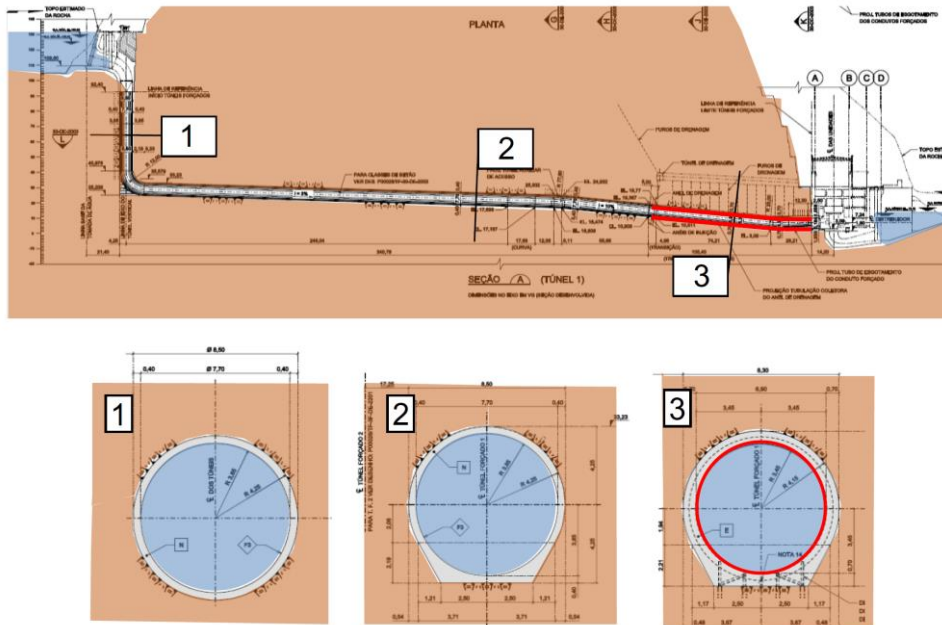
Corte longitudinal e secções transversais do circuito hidráulico do AHC – Central 2. Retirado de [1].
